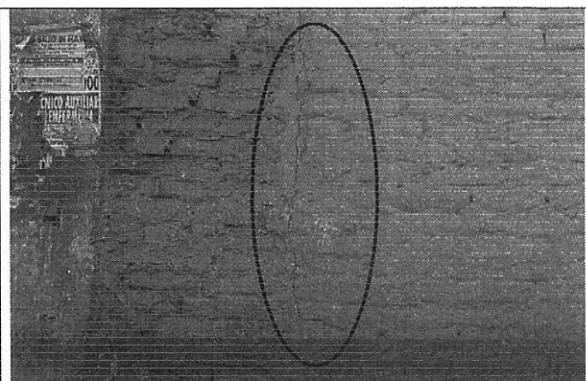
Fisura en el extremo norte del muro del costado occidental
